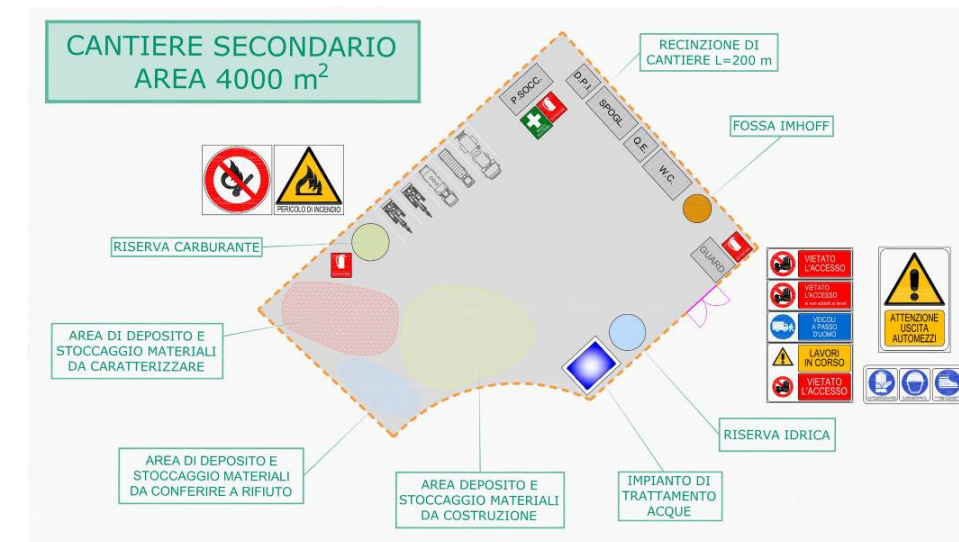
Tratto Cat. B - Planimetria lay-out cantiere secondario
